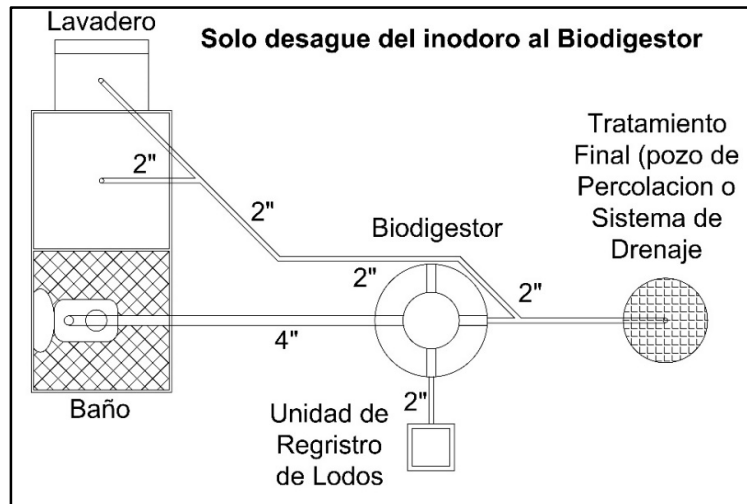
SISTEMA DE ALCANTARILLADO PROYECTADO.
